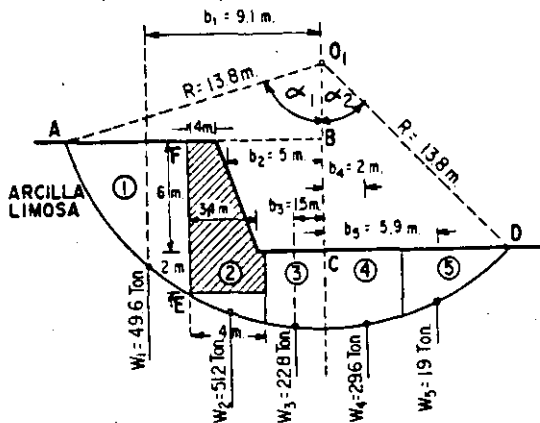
Planteamiento del problema y primer tanteo.
